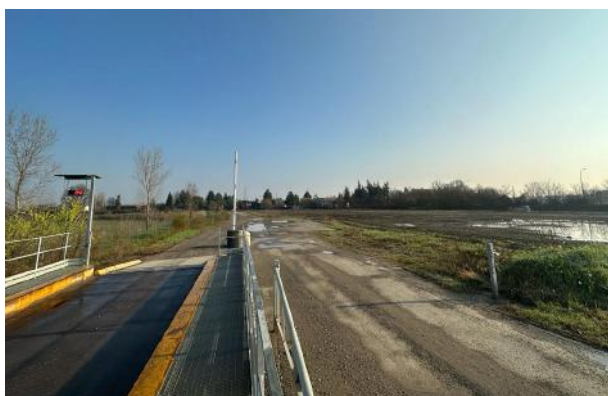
Vista verso sud dalla pesa posta lungo la strada di ingresso nel tratto che costeggia il futuro deposito End of Waste (vista 09)
